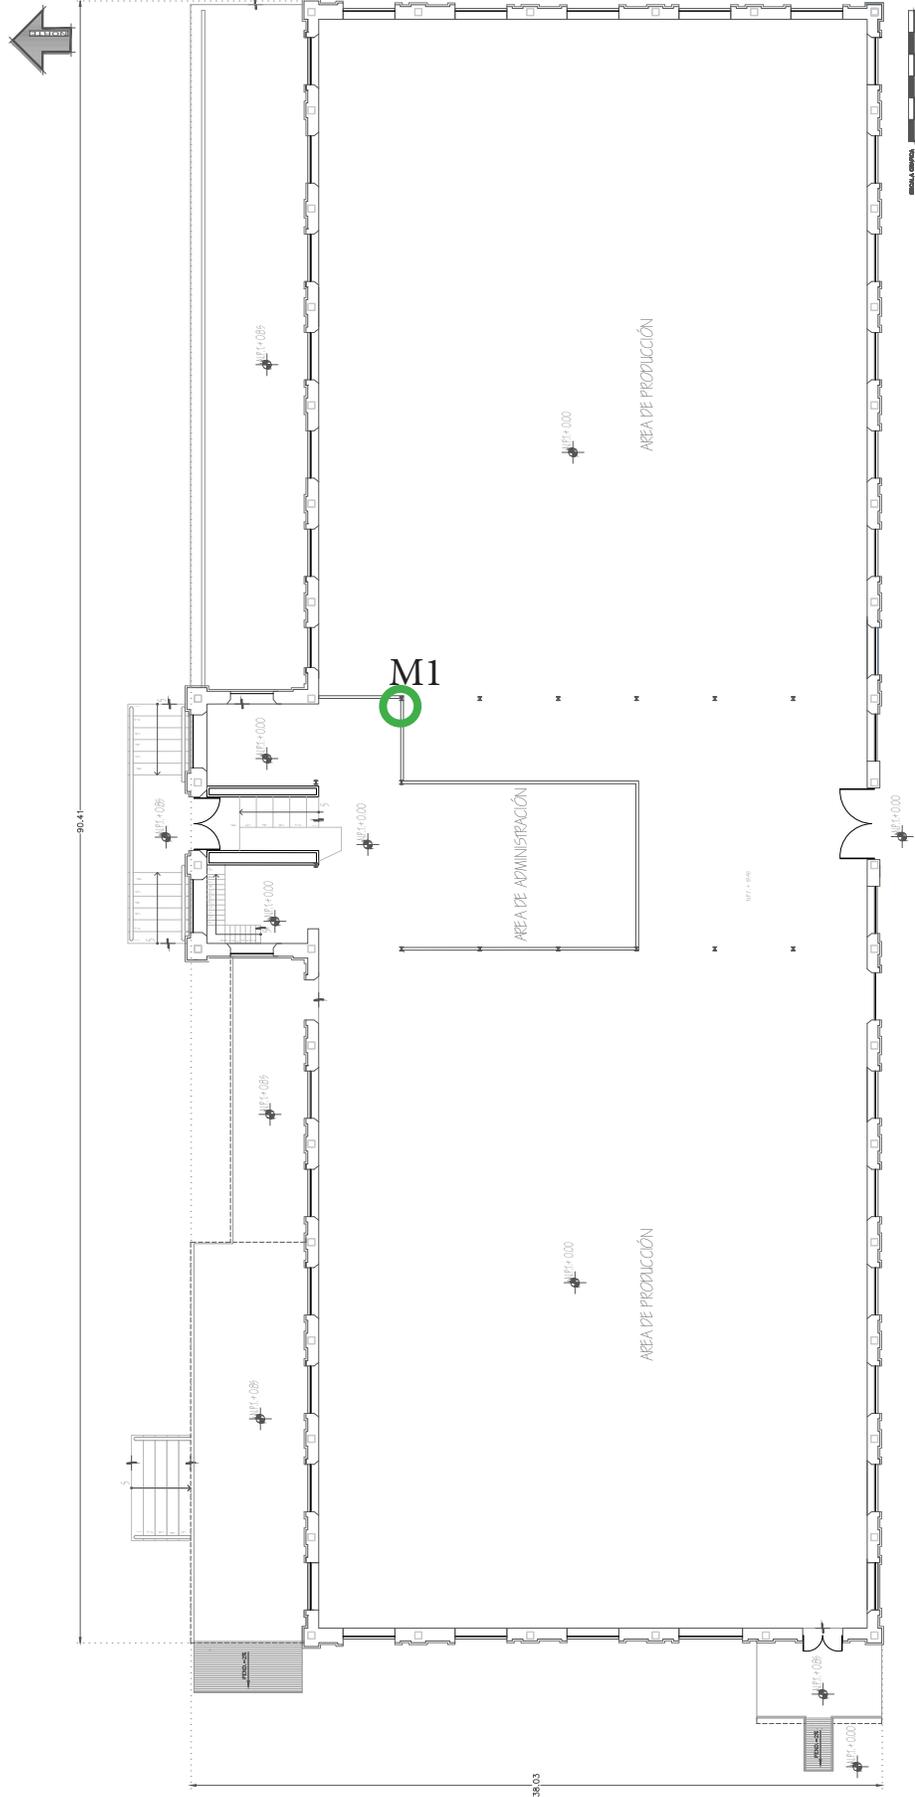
Planta arquitectónica edificio-B central, ubicación de la toma de muestra 1 (M1)
